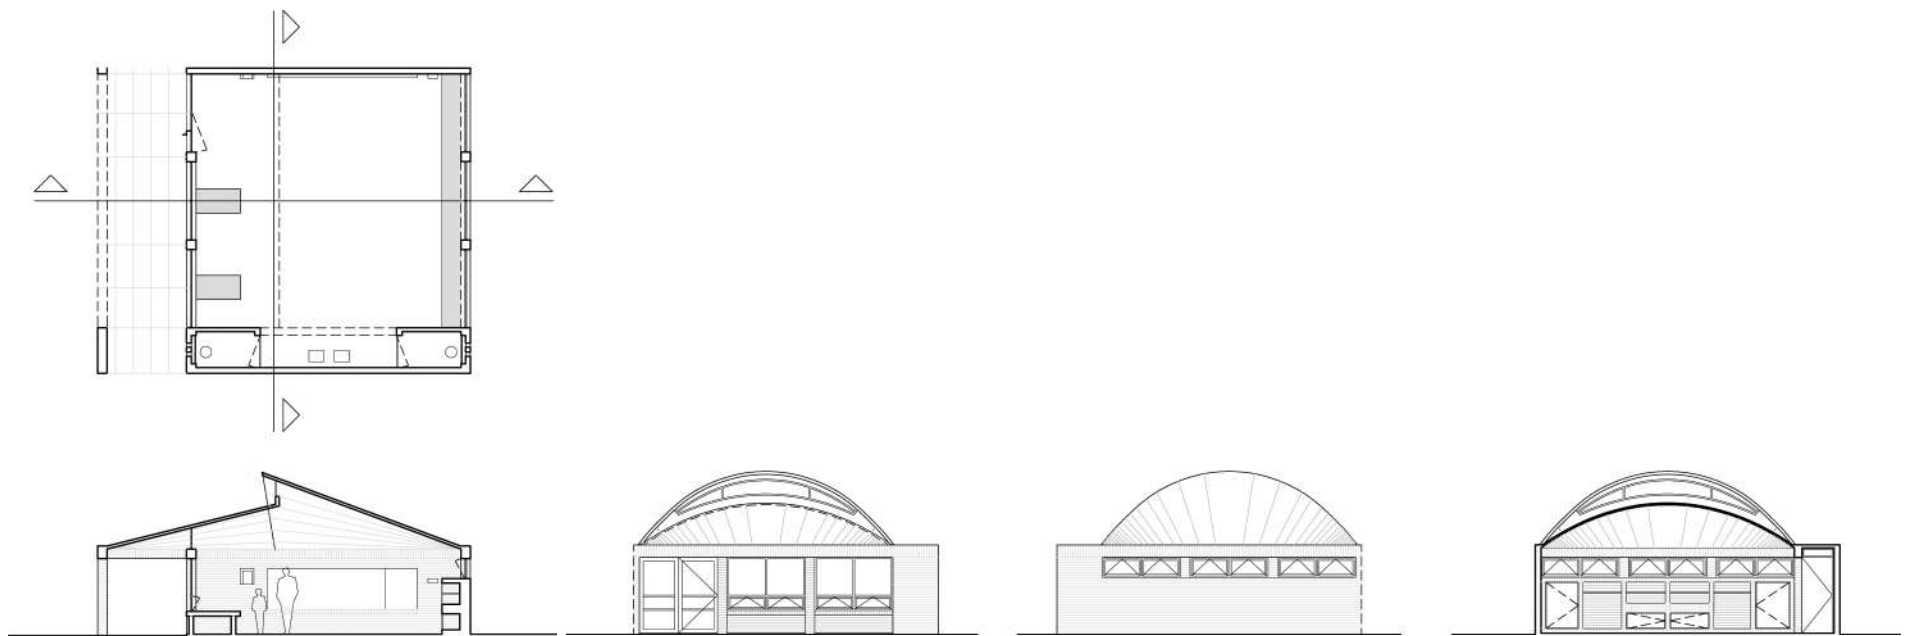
Planta, cortes y alzados *Aula Integral* versión E1, escala 1:200. Fuente: dibujos del autor.
